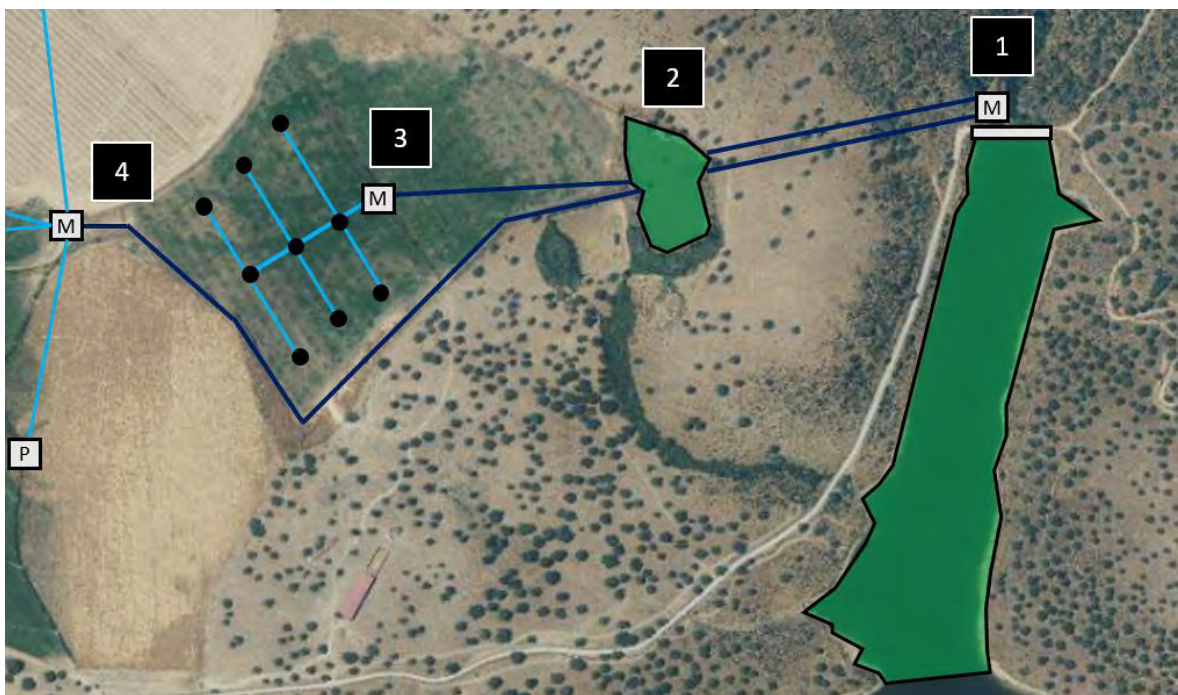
Disposición de los tramos de tuberías de 200 mm (Fuente: elaboración propia, 2023).
